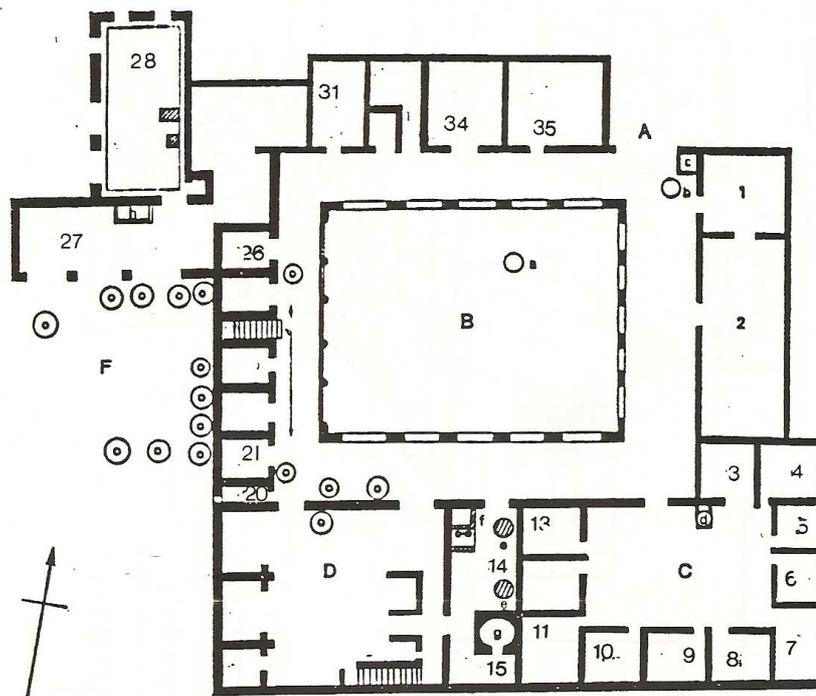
Planimetria reconstruída de um edifício rural próximo a Pompéia (R-34)
